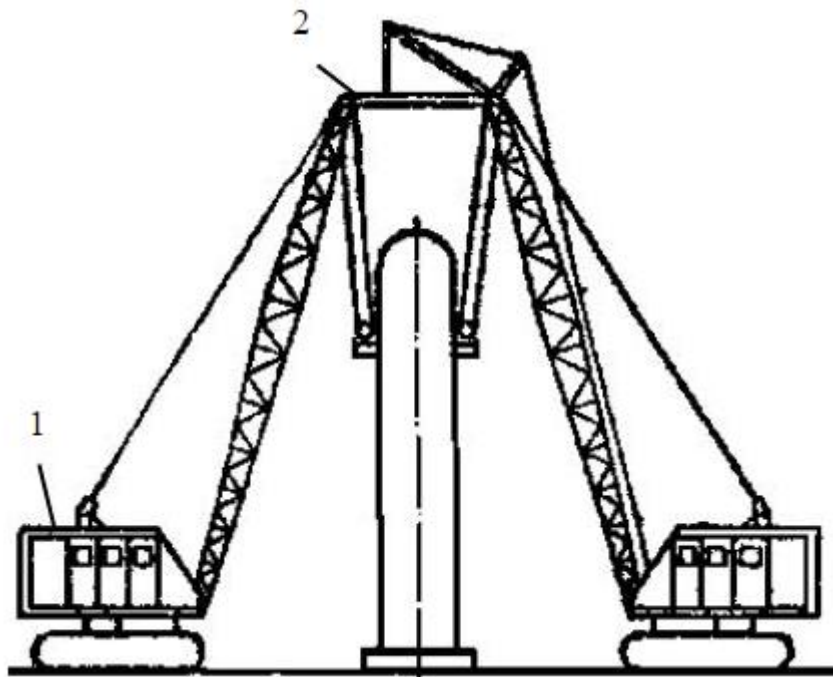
Схема кранов со стрелами, соединенными ригелем:
